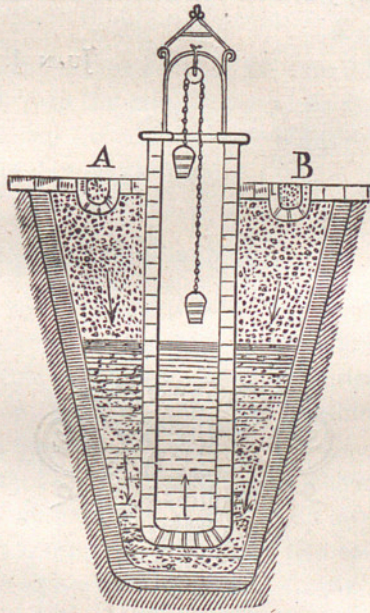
Cisternas de Venecia con aparato de filtracion.
